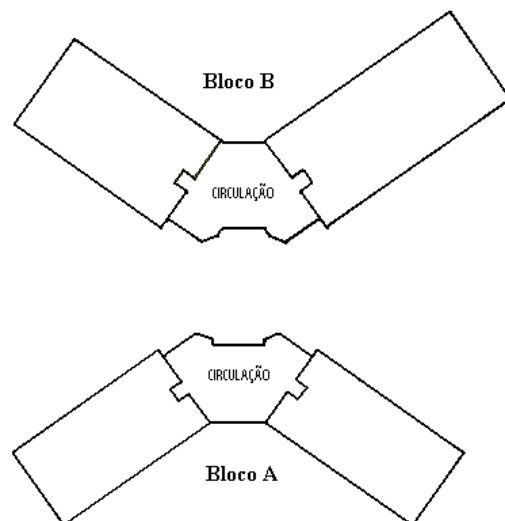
Planta baixa esquemática do pavimento térreo do Departamento de Engenharia Civil .
